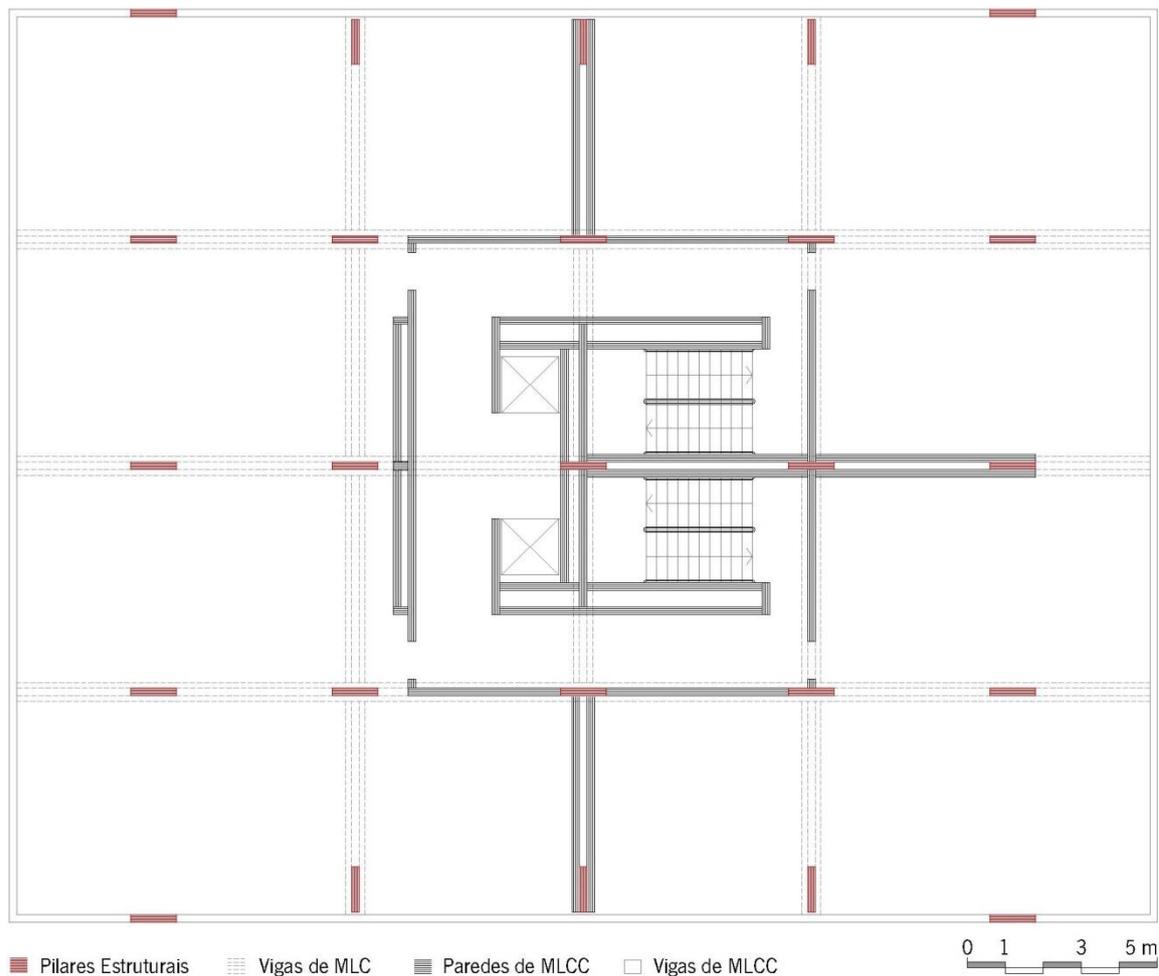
Planta de Piso-tipo com Elementos Estruturais do Tipo MLCC 200 mm L5s
